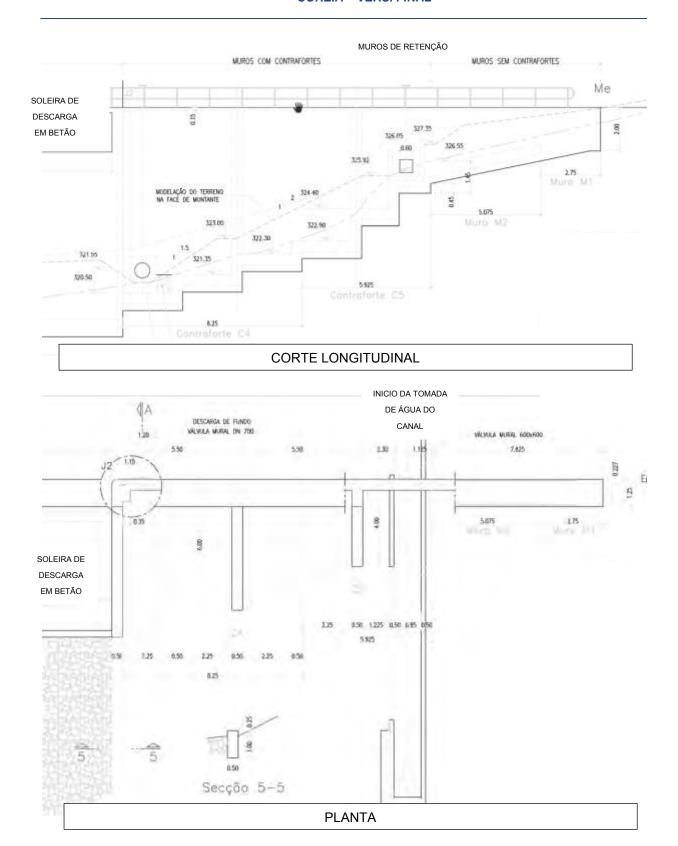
Corte e planta indicativa do muro de captação e da soleira de descarga
